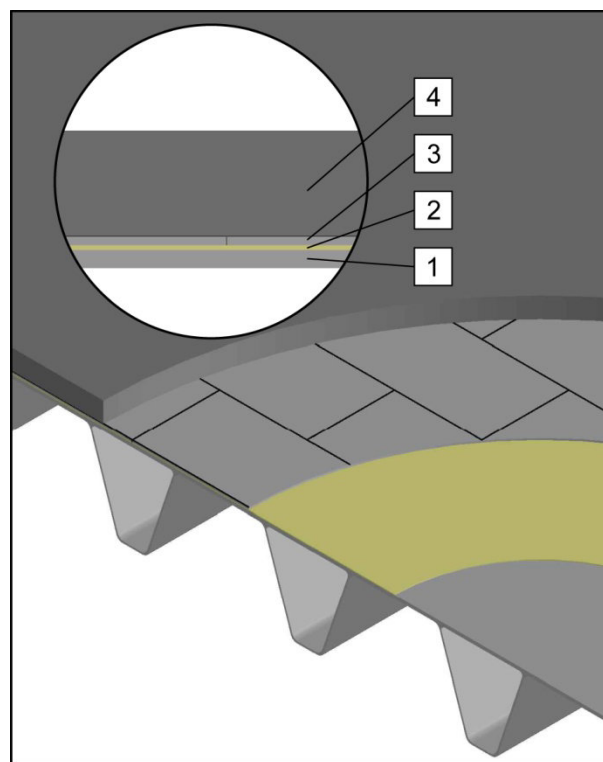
Hochfester Beton mit Stahlfasern: 12 mm Stahldeckblech (1); 10 mm mit Bauxit abgestreutes Epoxidharz (2); 60 mm, hochfester Beton (3); 10 mm reaktionsharz-gebundener Dünnbelag (4)
